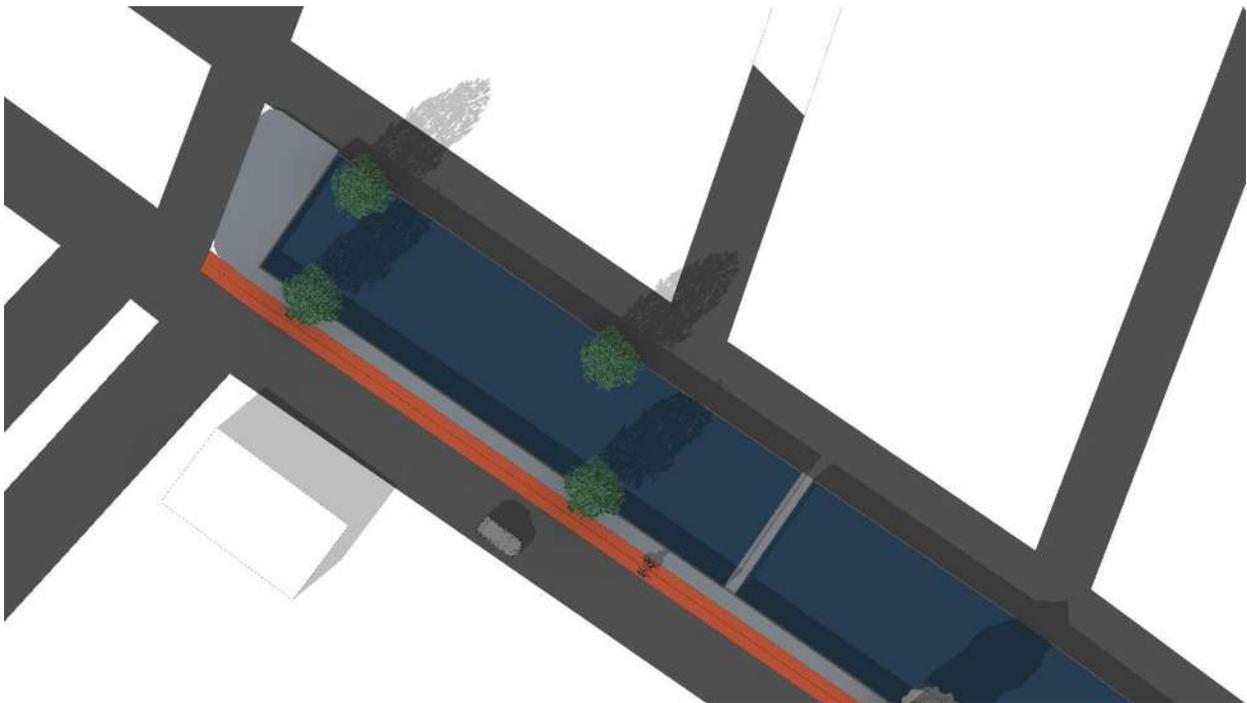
Vista en planta de propuesta de diseño 1. Elaboración propia.
